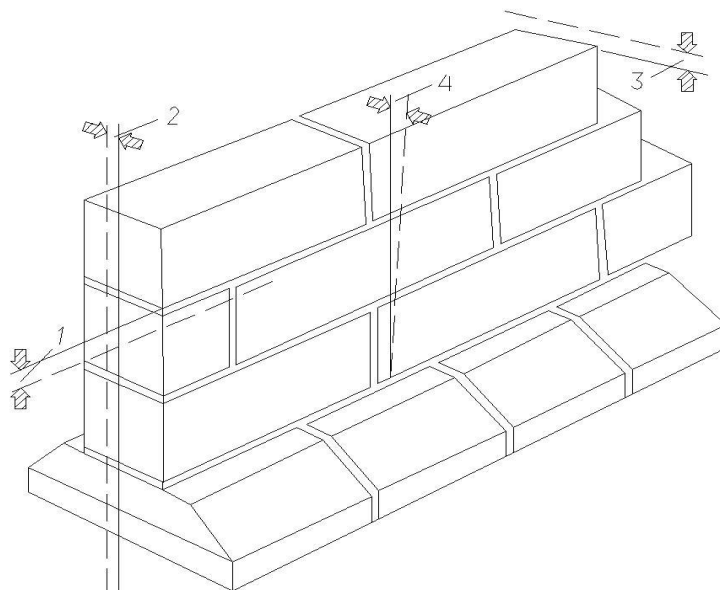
Збірний залізобетонний фундамент: 1-відхилення рядів кладки від горизонталі; 2-відхилення від розбивочної вісі фундаменту; 3-відхилення по відмітках зрізів; 4-відхилення бокових поверхонь і кутів фундаменту від вертикалі.
